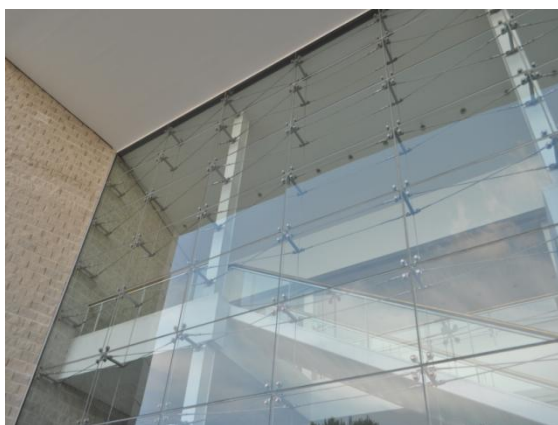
Fachada envidraçada do Teatro de Camões.
